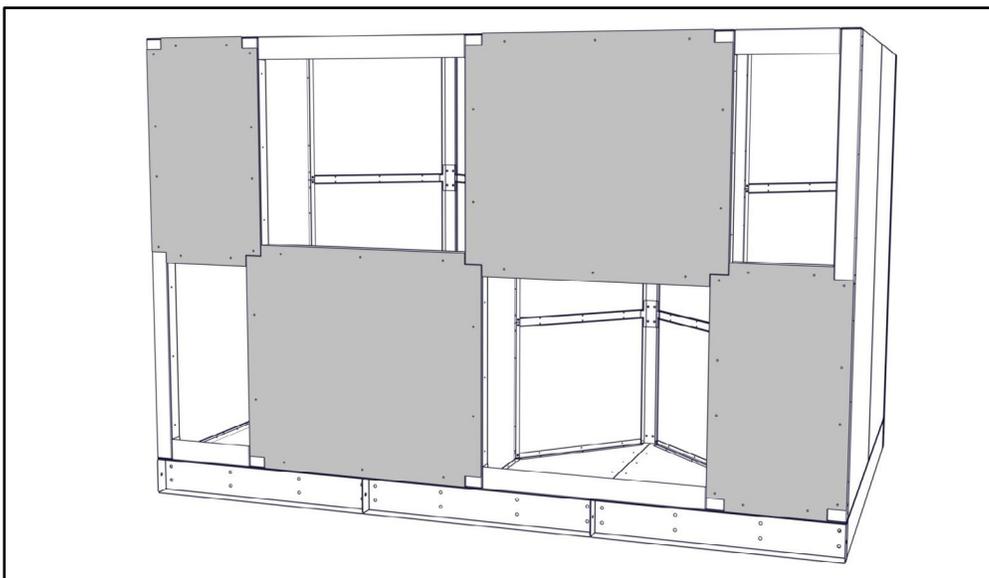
INSTALLER LES PANNEAUX DE LA PLAQUE FRONTALE
